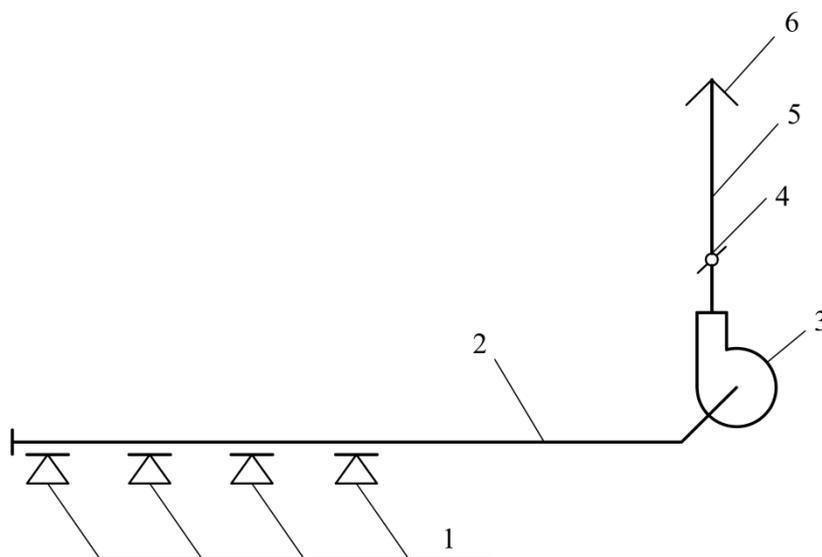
Схема общеобменной вытяжной вентиляционной системы: 1 – воздухоприемные решетки; 2 – воздуховоды; 3 – вентилятор; 4 – дроссель-клапан; 5 – вытяжная шахта; 6 – зонт (флюгарок)
